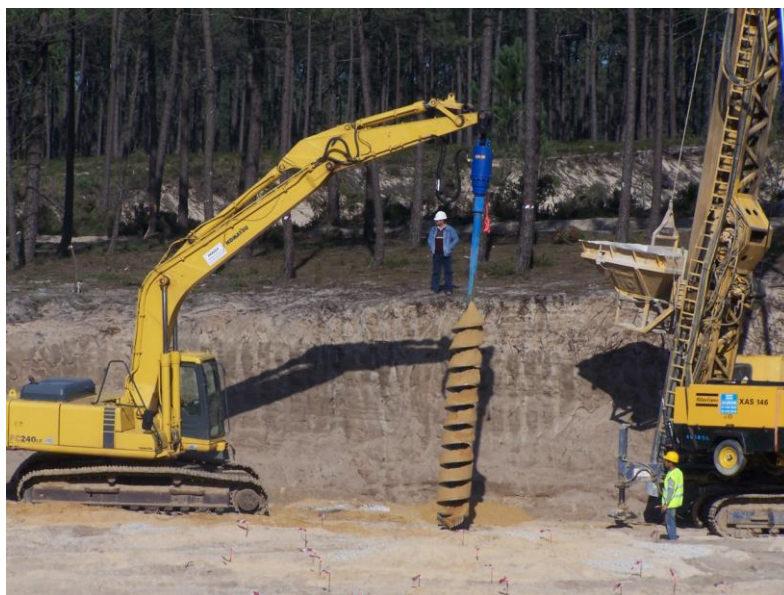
Exemplo de equipamento de pré-furação, com trado de diâmetro mínimo de 600 mm.
